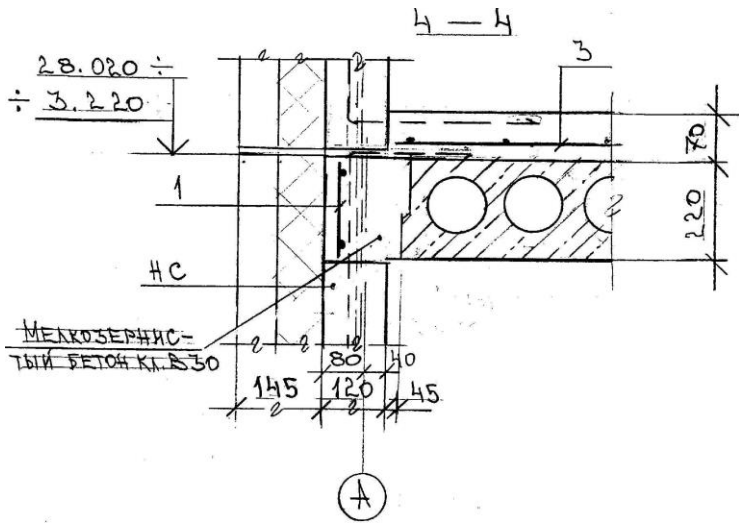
Примикания плиты перекрытия до внешней стены
